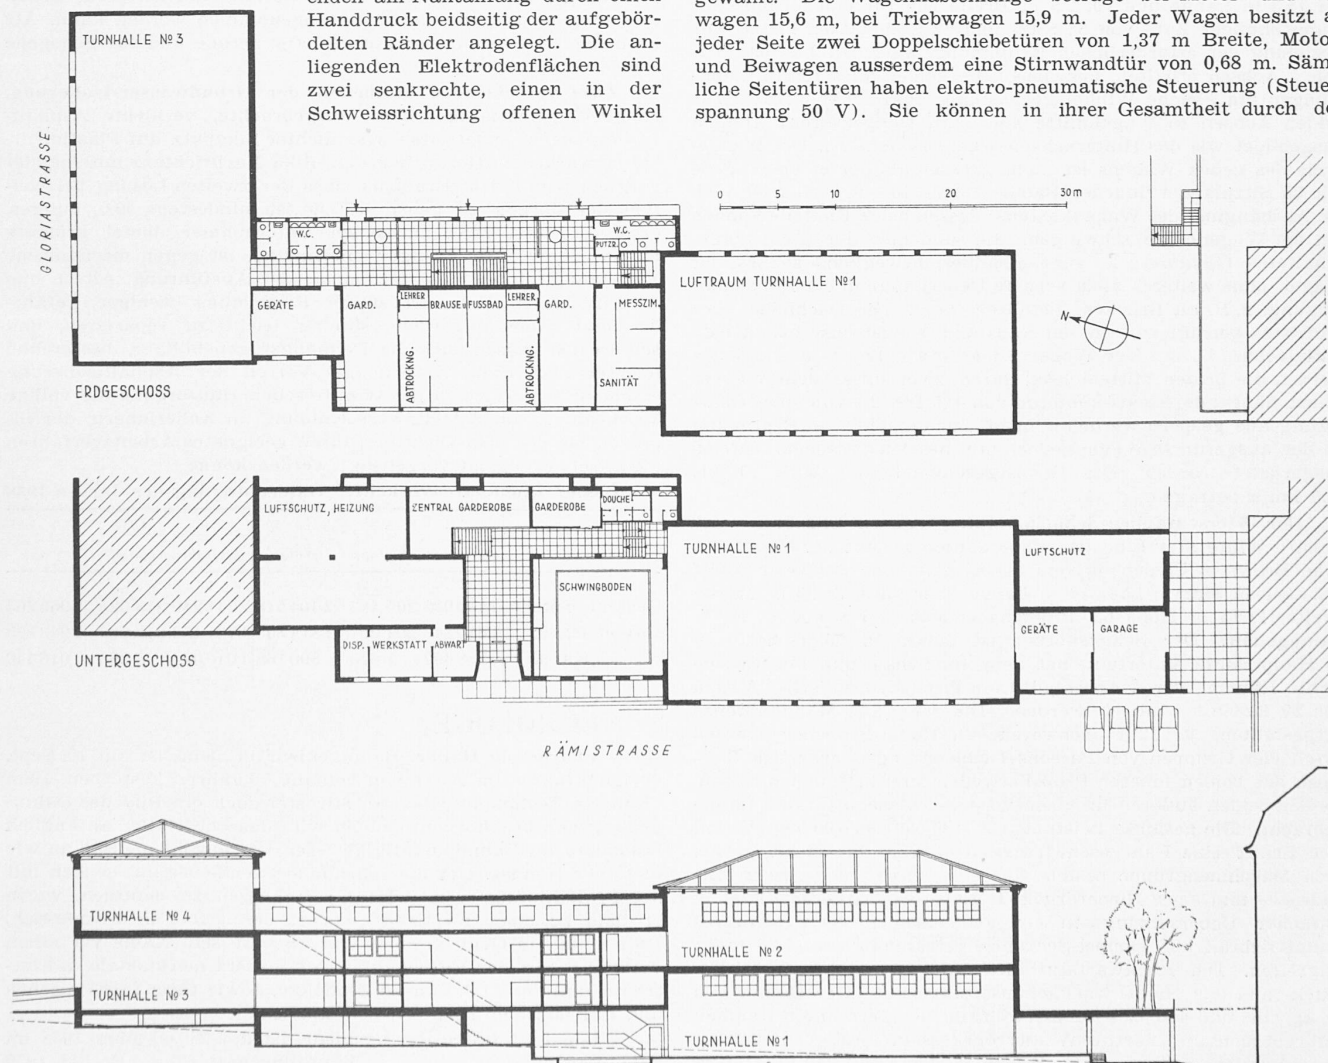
und 2. Grundrisse und Längsschnitt der neuen Kantonalen Turnhallen in Zürich. — Arch. Dr. HERM. FIETZ, Zollikon. — 1:600
